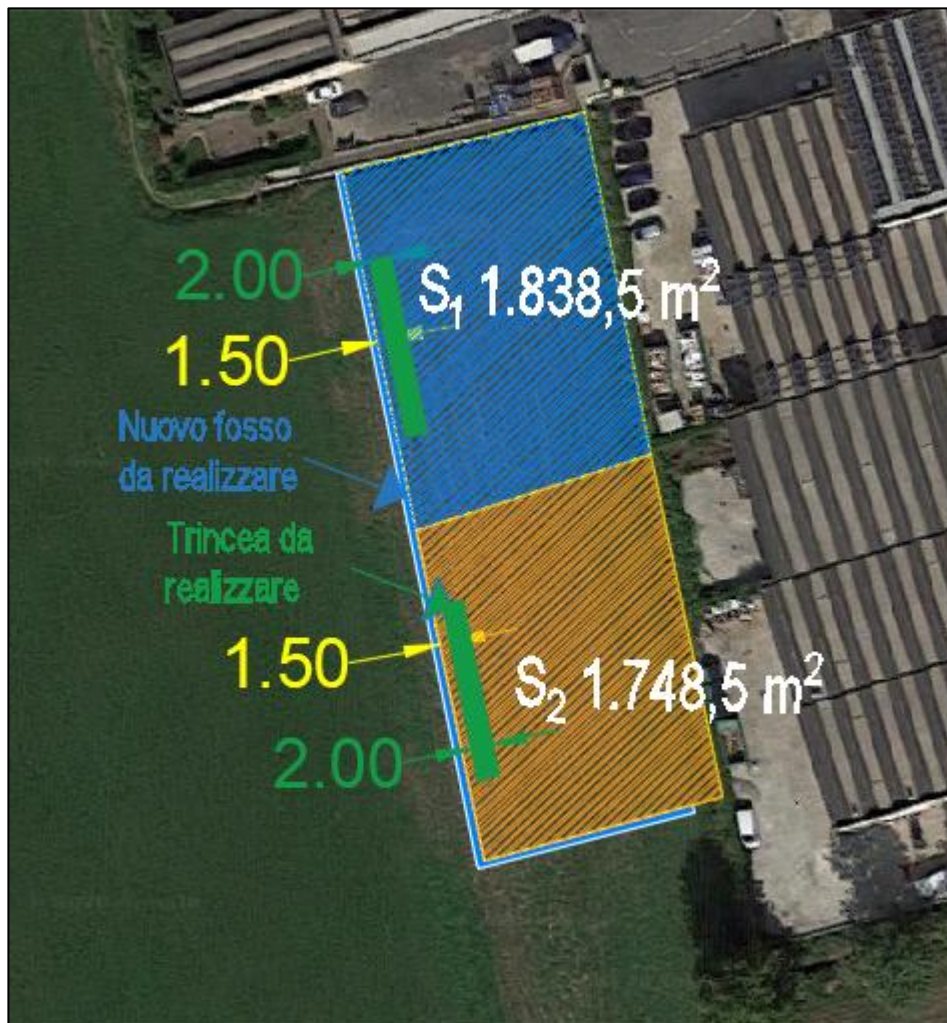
Planimetria con indicazione dei dispositivi di dispersione (trincee) di progetto
